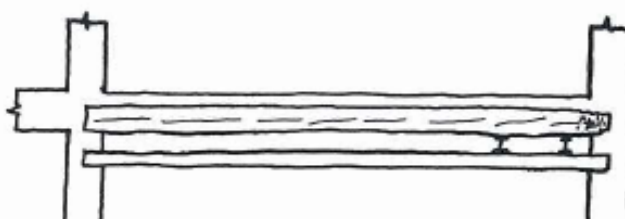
Reforço por colocação de perfis metálicos sob as vigas (Arriaga [21])
